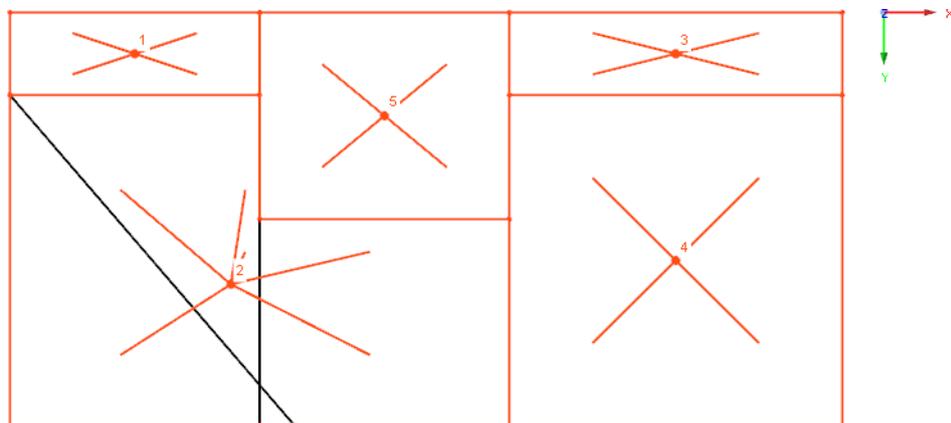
Bühnenkonstruktion mit Zellen für Lastgenerierung
